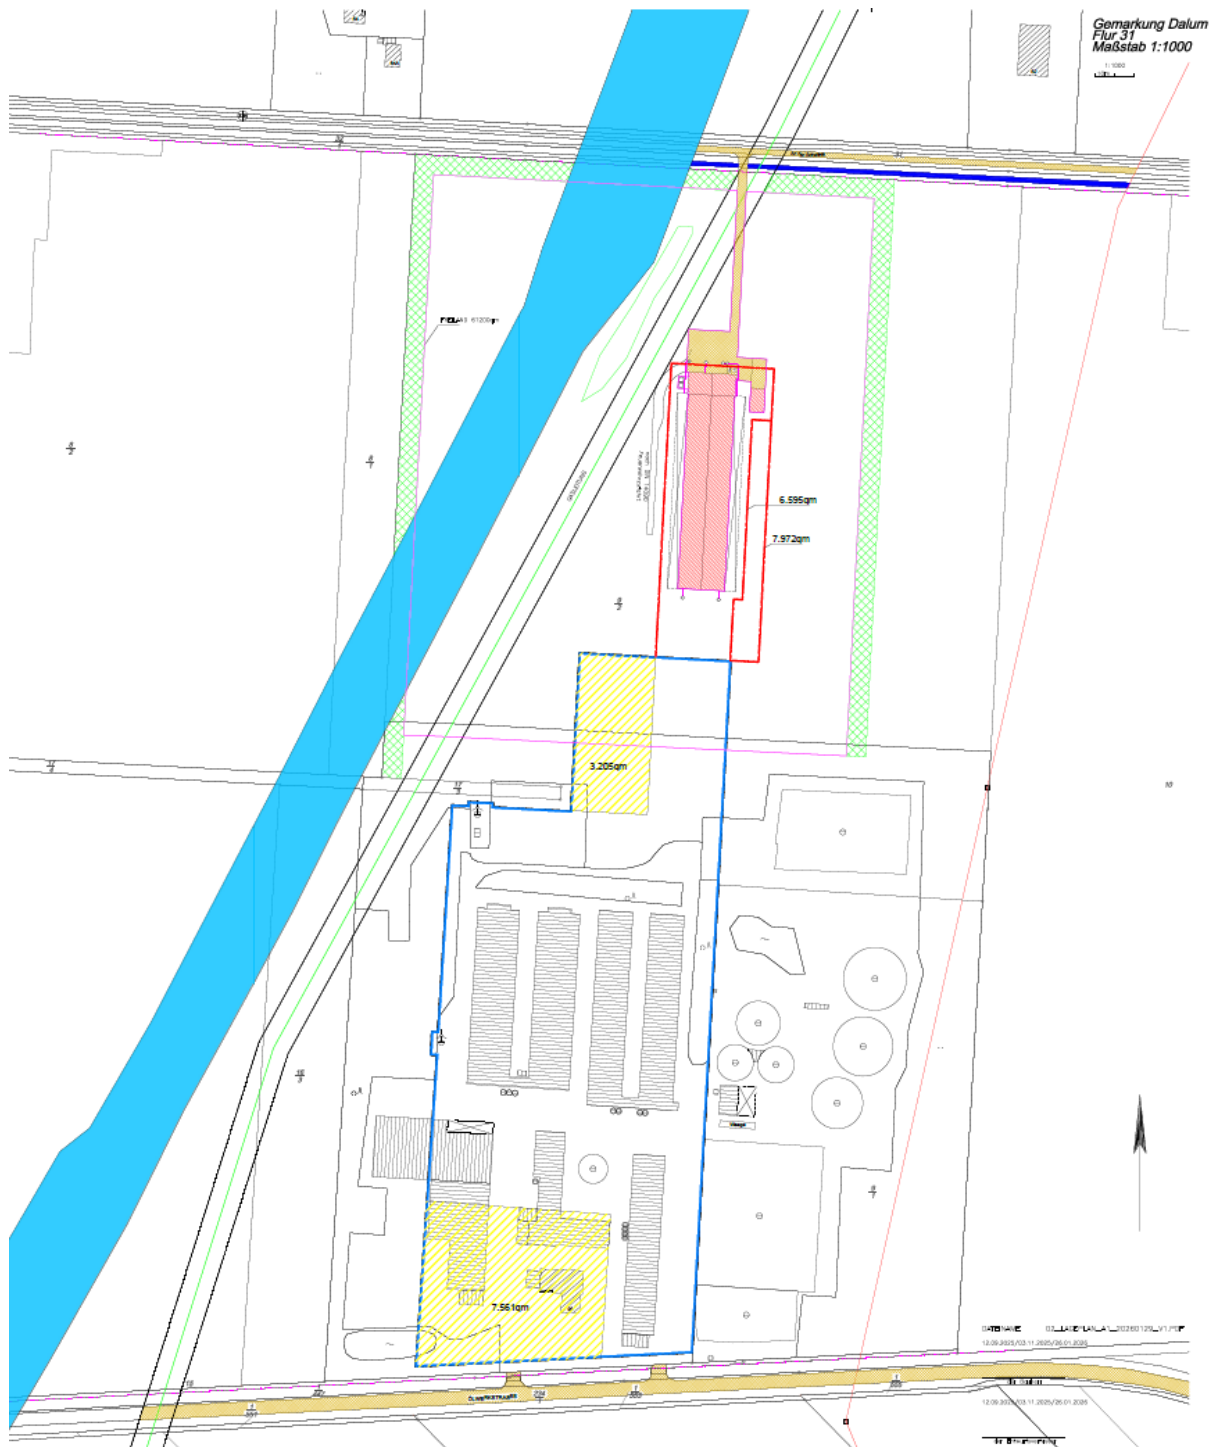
Lageplan zum Bauvorhaben (Bouws 2026) (unmaßstäblich)
